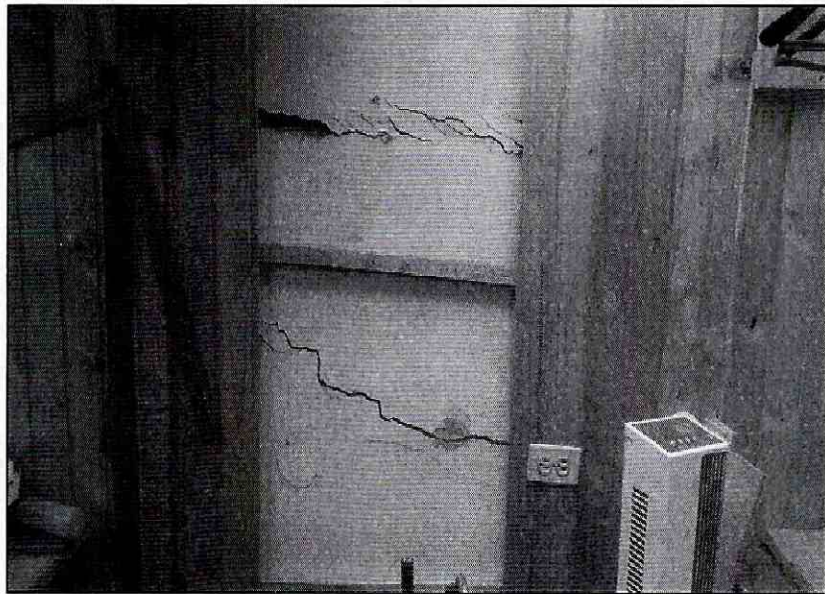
Grietas con tendencia diagonal en muro del costado norte – primer piso
